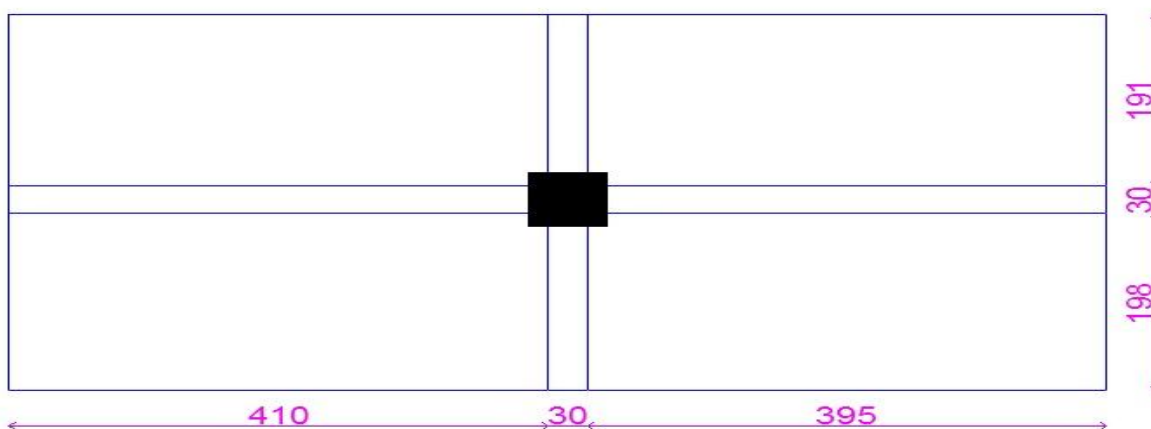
Surface d'influence sur le poteau central côté entrepôt
